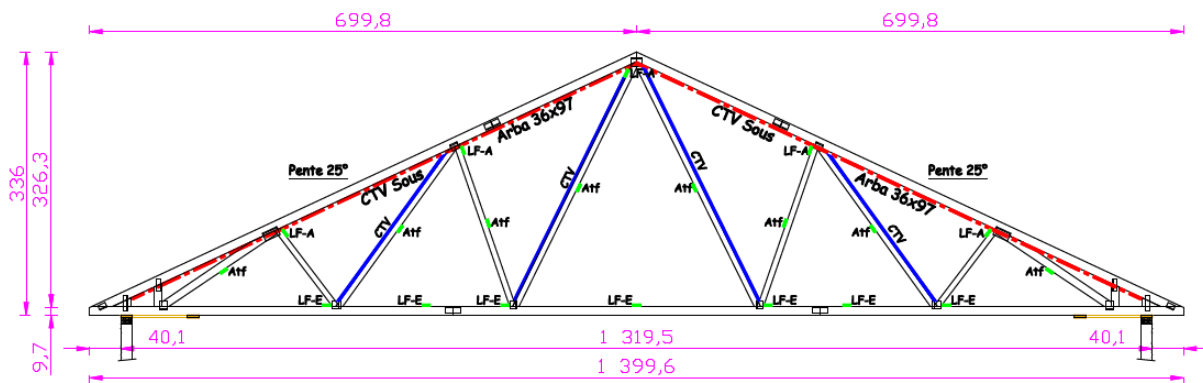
Plan de ferme courante et détail de fixation sur l'ossature
